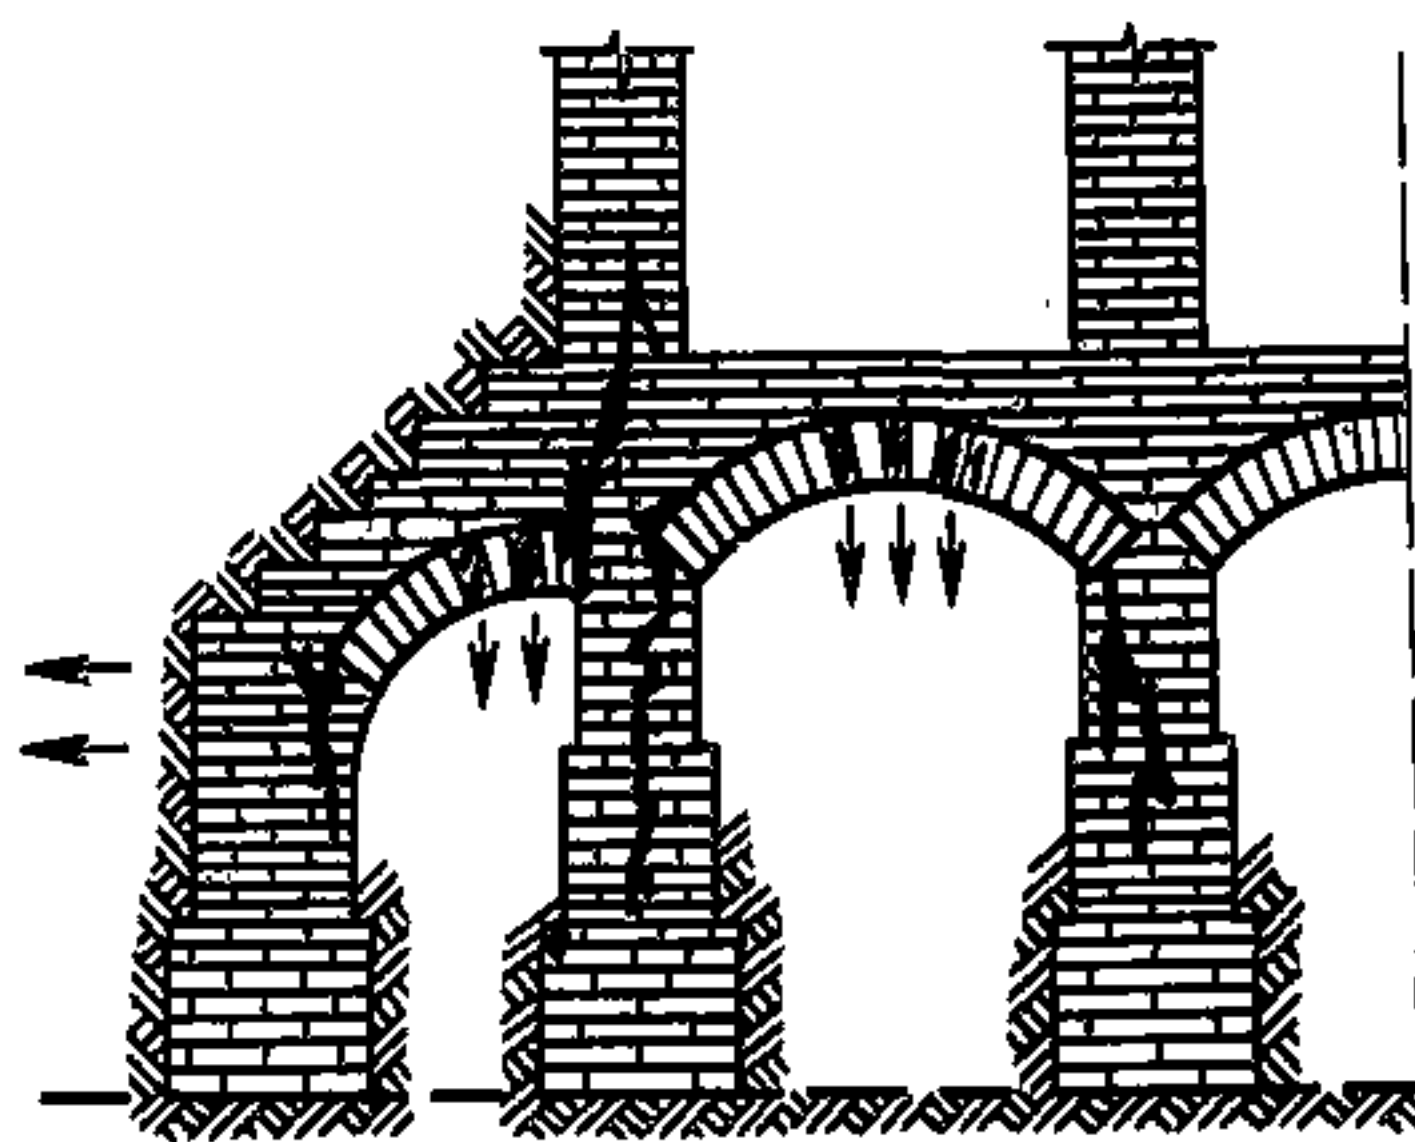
Трещины в пяте свода, опирающегося на фундамент
